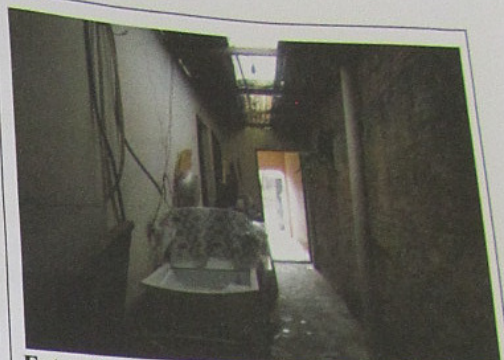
Vista do corredor lateral, do fundo para a frente.
